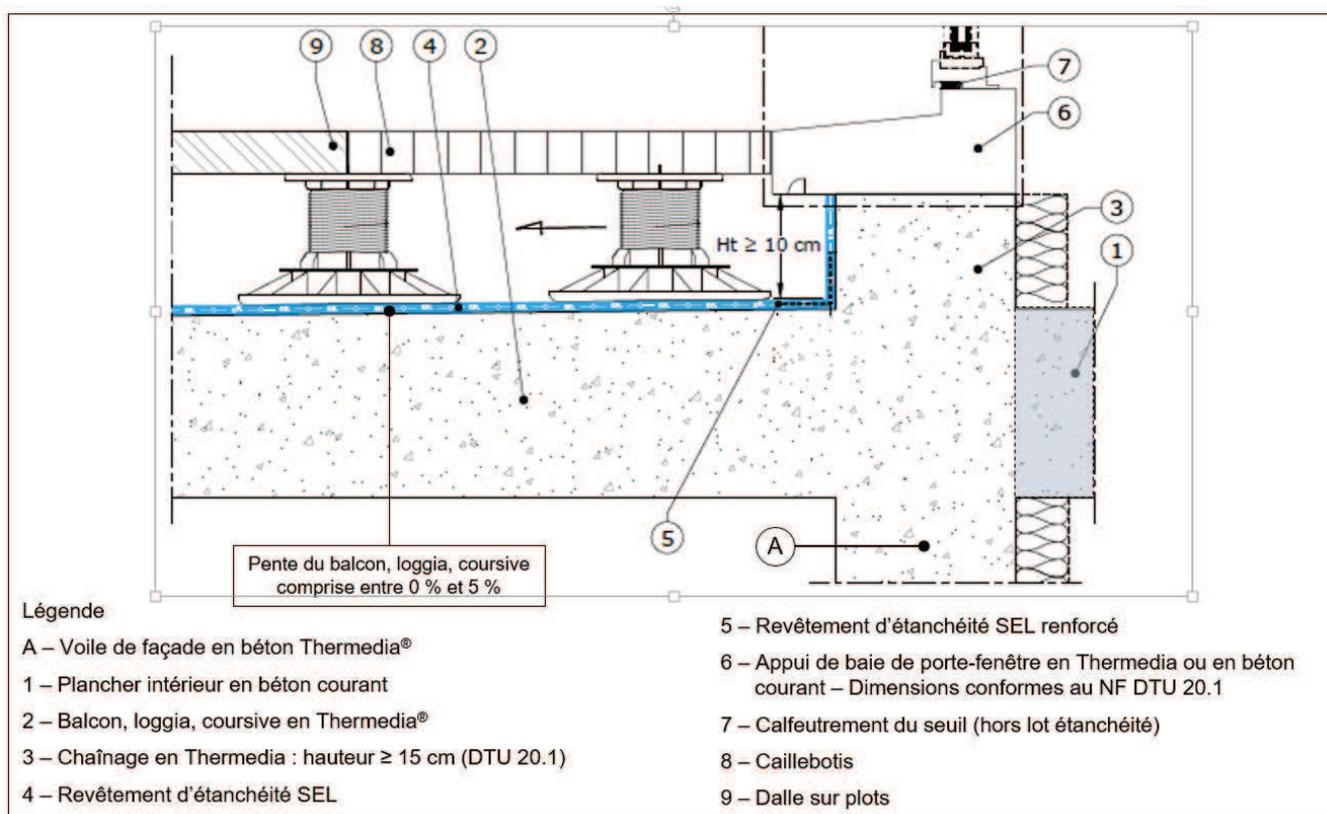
Exemple de balcon, loggia ou coursive avec étanchéité par un S.E.L. avec protection par dalles sur plots - Seuil avec relevé de 10 cm de hauteur.
